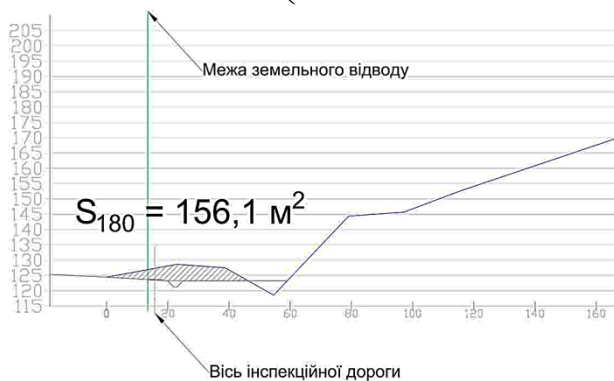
Поперечний переріз тіла зсуву м.о. 180 (заштриховане – переріз порід, що підлягають вийманню)
